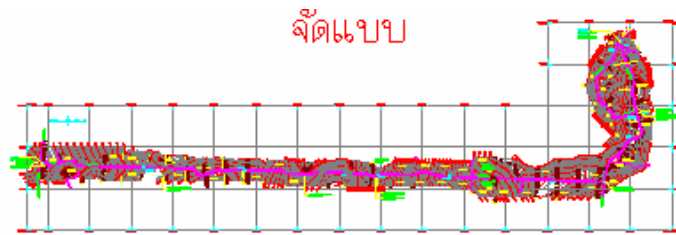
แสดงแผนที่ Site Plan ระบบคิติดอล บริเวณ Spillway
